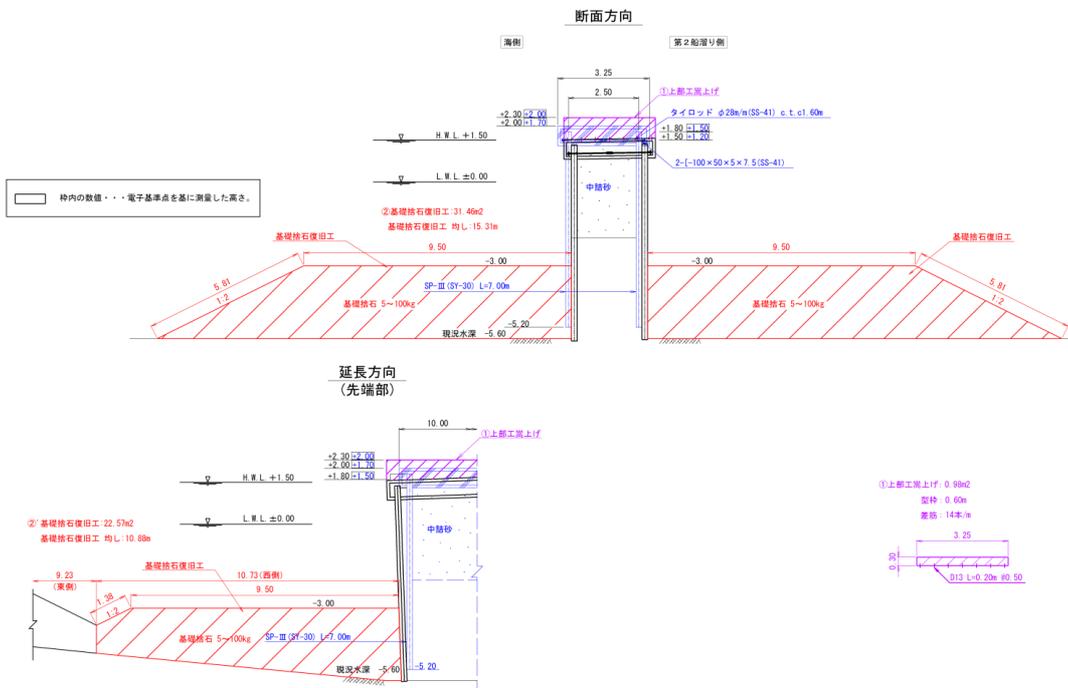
No.15 日立港区_第5埠頭地区第2船だまりの西断面図(復旧後)
